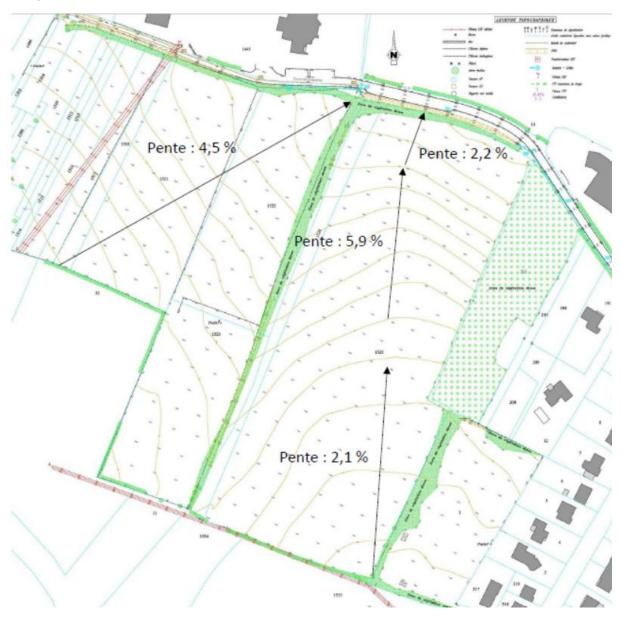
Topographie générale (pente Sud/Nord) du secteur des Ganaudières
